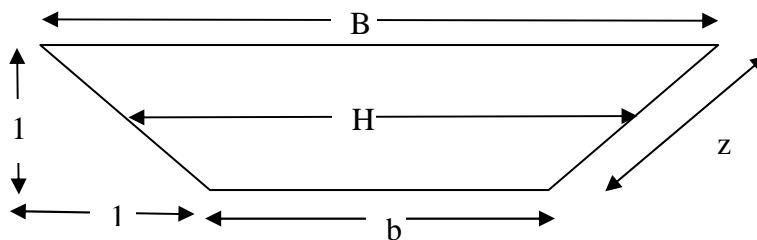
Coupe transversale d'un bassin de stockage trapézoïdal
